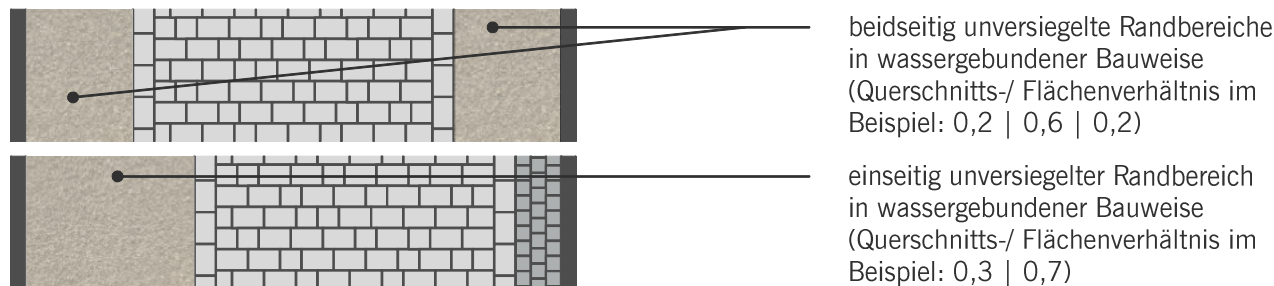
+24.3 Ausbauprinzip optional mit geringerer Versiegelung der Oberfläche
